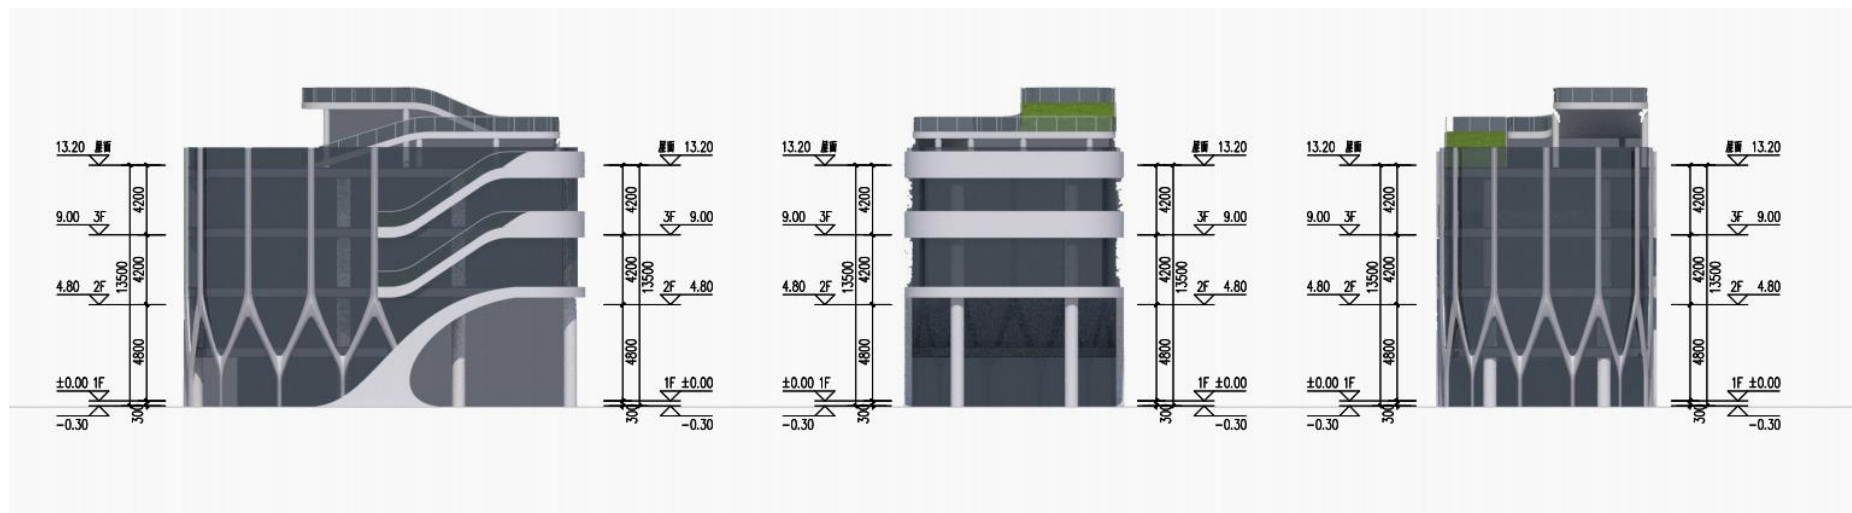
科普教育培训配套服务基地西南立面图（左）、东南立面图（中）及西北立面图（右）
